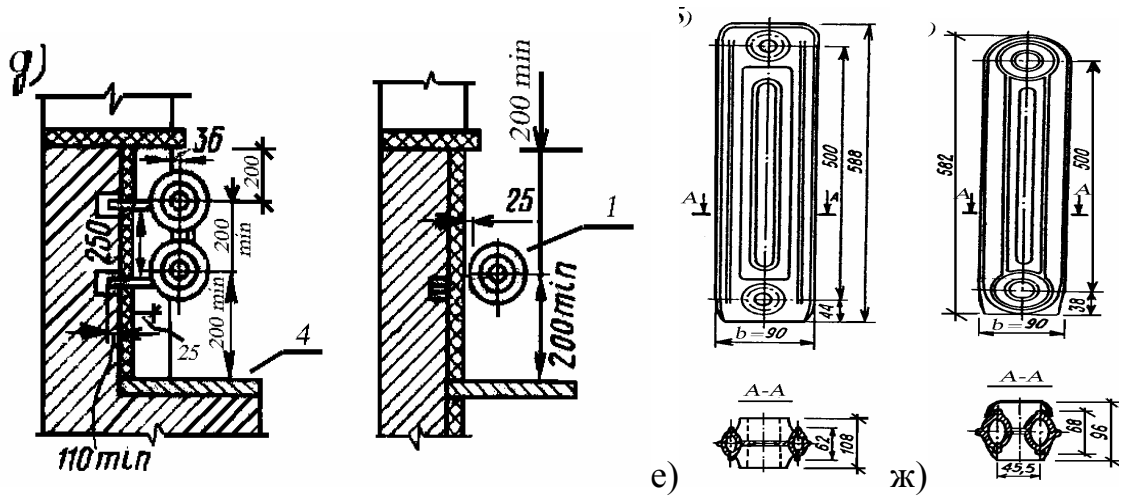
Схемы установок отопительных приборов у пола помещений:
